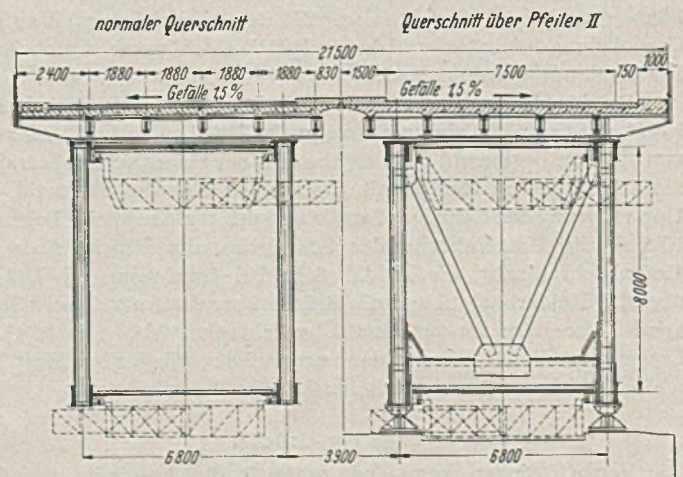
Querschnitte zum Ausführungsentwurf.
